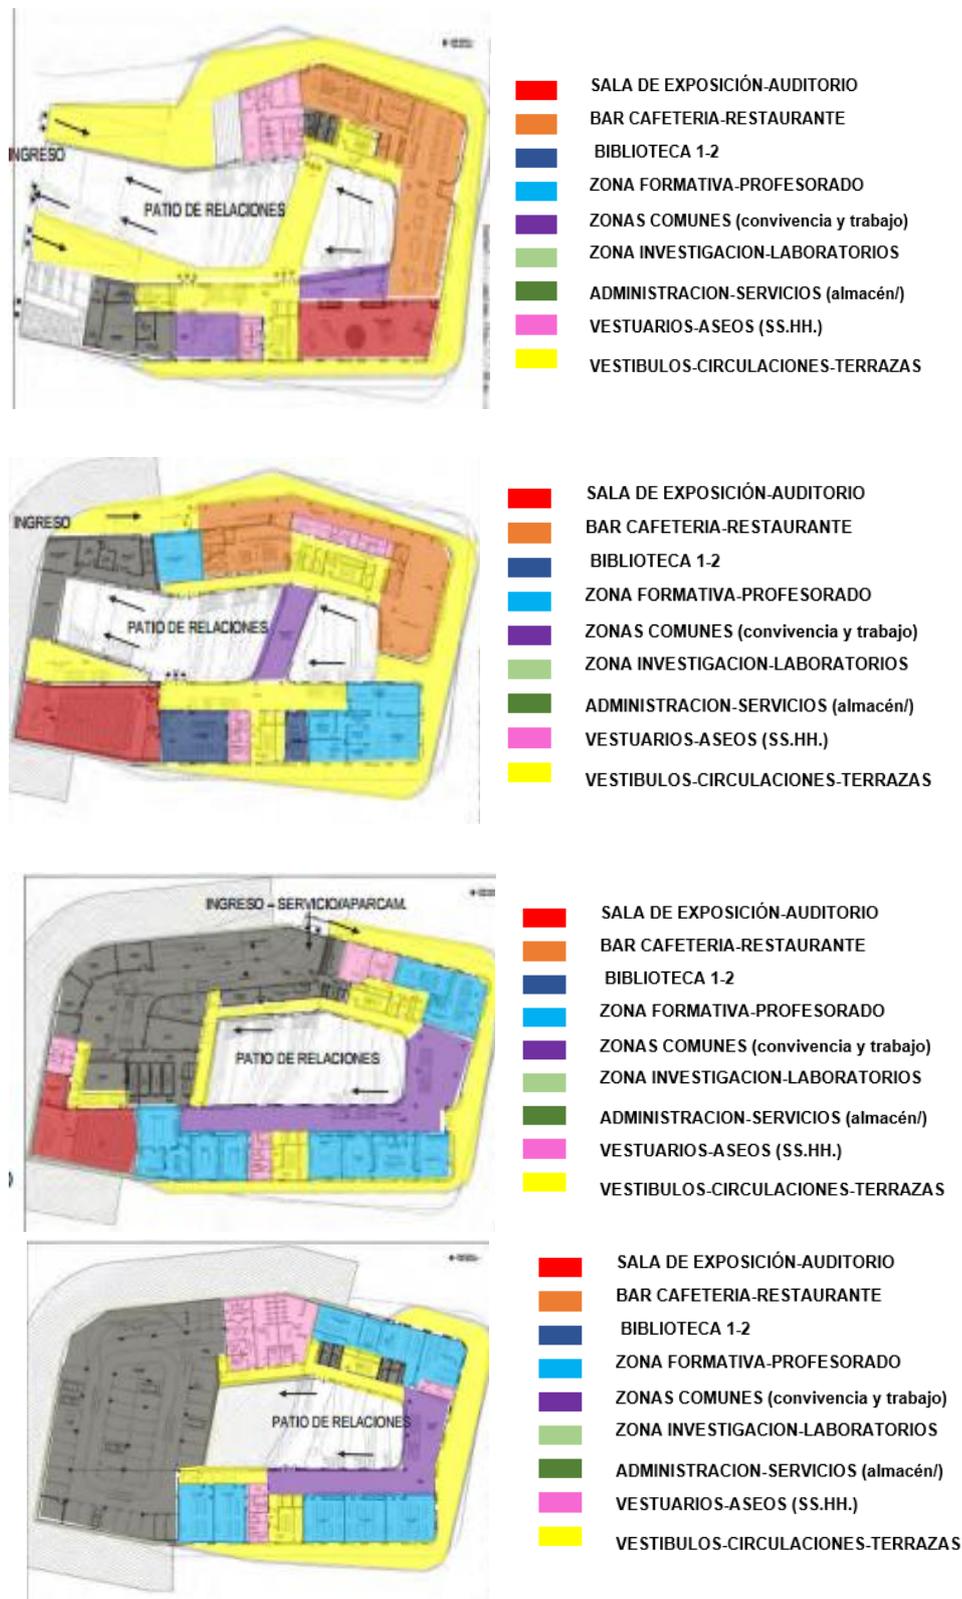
Esquema de zonificación planta 0-3 Basque Culinary Center
